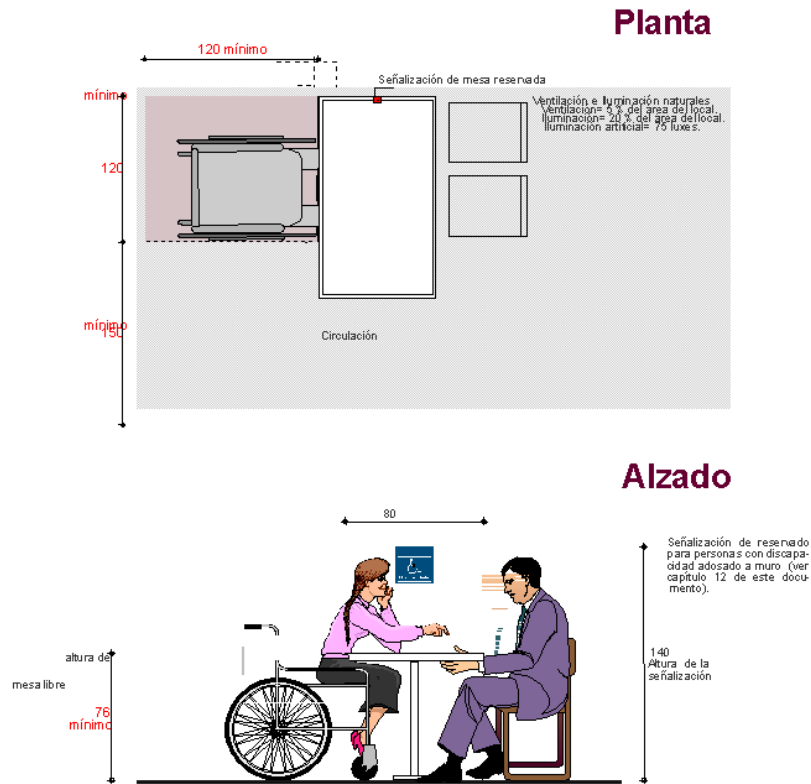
Plano en planta y elevación para guía en el diseño del comedor
